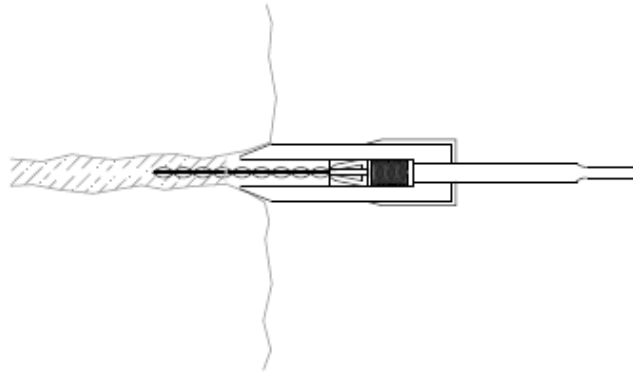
Fase 1: Introdução da armadura com ajuda da máquina
